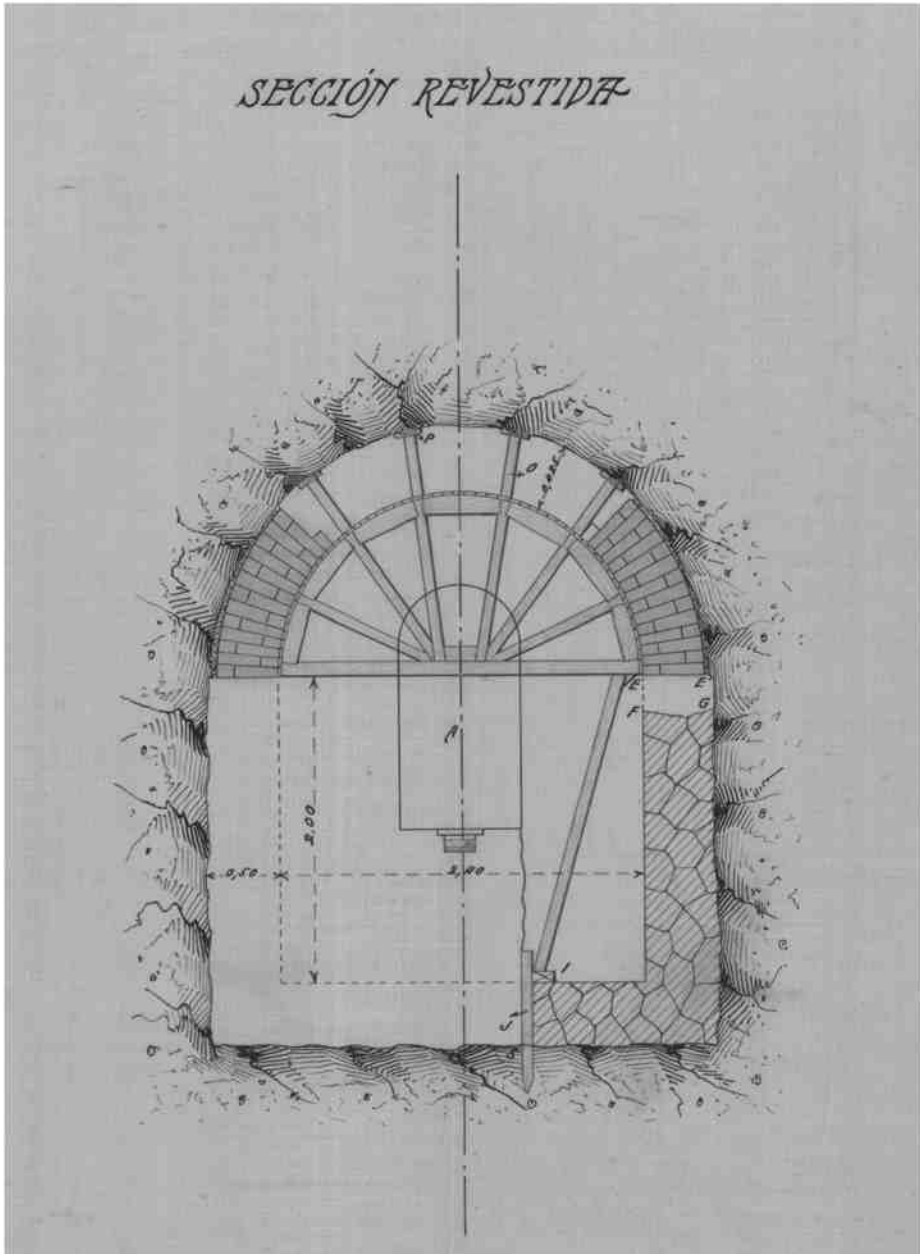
Sección de los túneles con la base de mampostería y revestimiento de ladrillo (A.G.A.)
